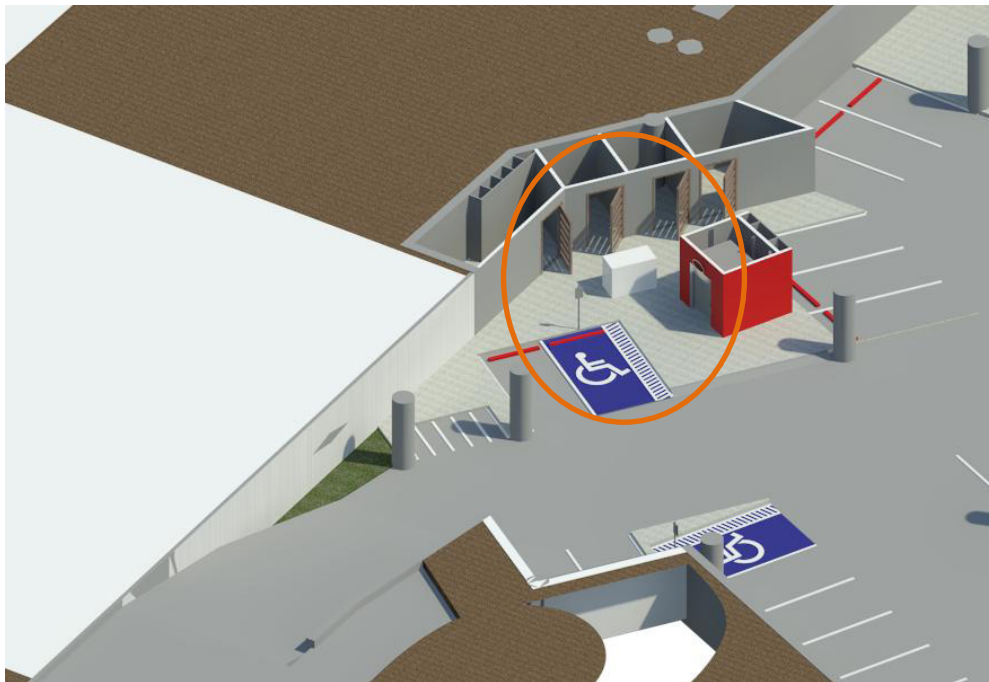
Ubicación planta de Emergencias en el Sótano del Centro Cultural. Fuente: Propia
